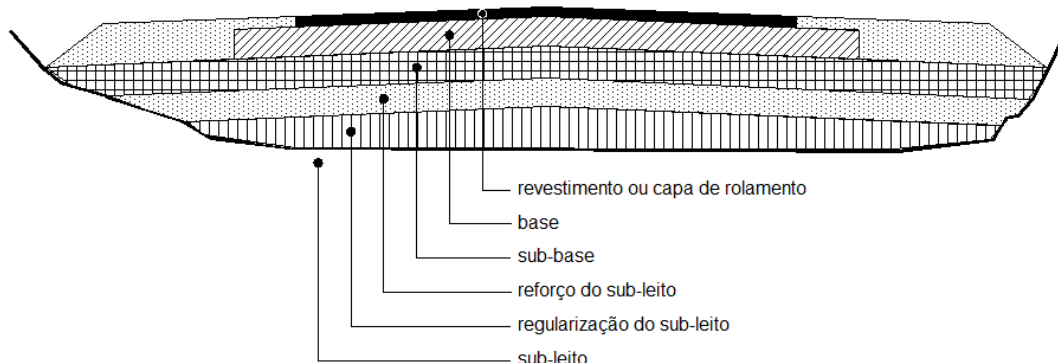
Esquema das camadas de um pavimento. FONTE: Faleiros, 2005, p. 4
